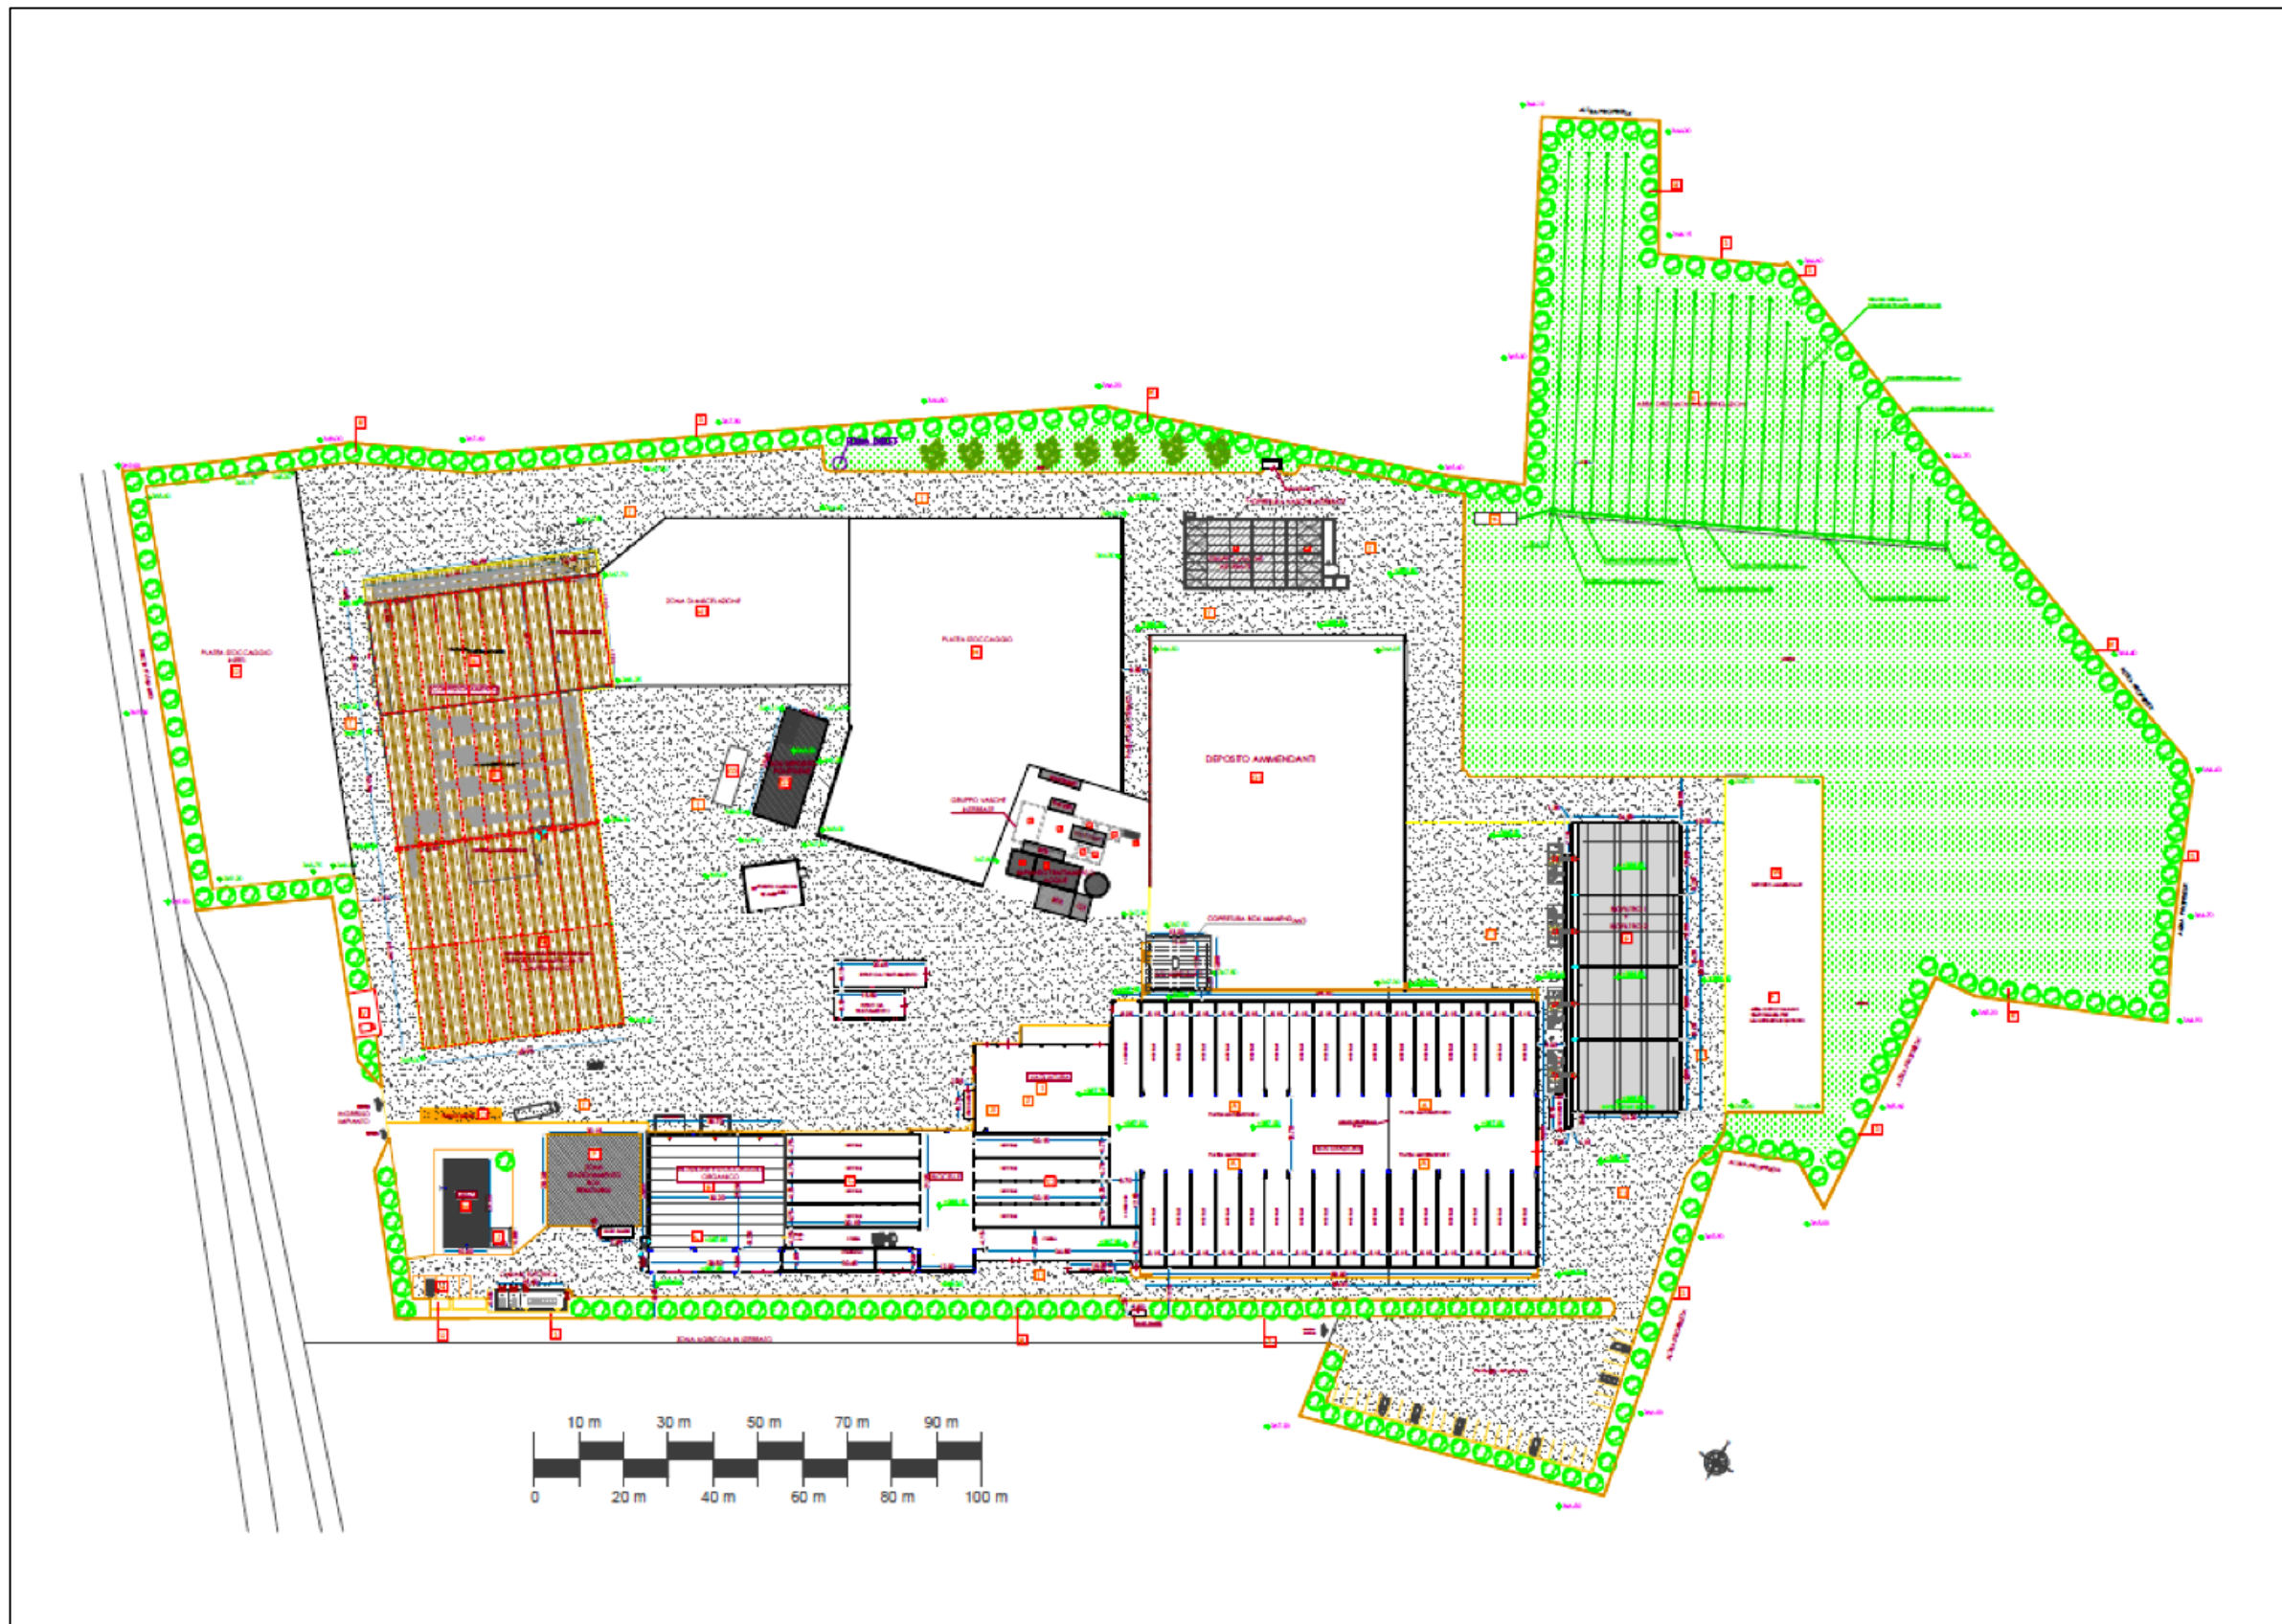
Planimetria generale Primo stralcio funzionale al 31.12.2018
